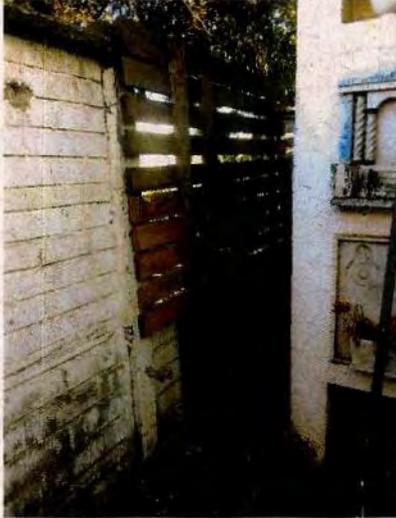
05/04/18: Vista exterior de ruptura en unión de pilar y muro de cierre perimetral en tramo de deslinde suroriente del sector "Parque" del establecimiento.
